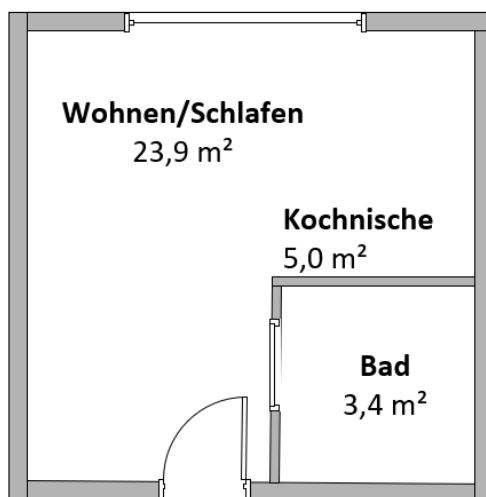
Grundriss Studentenapartment [16]
